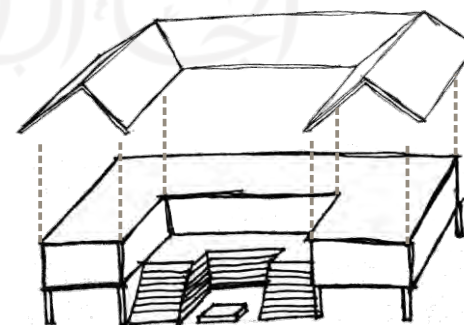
Alternatif 2 Penerapan Ornamen pada bangunan
